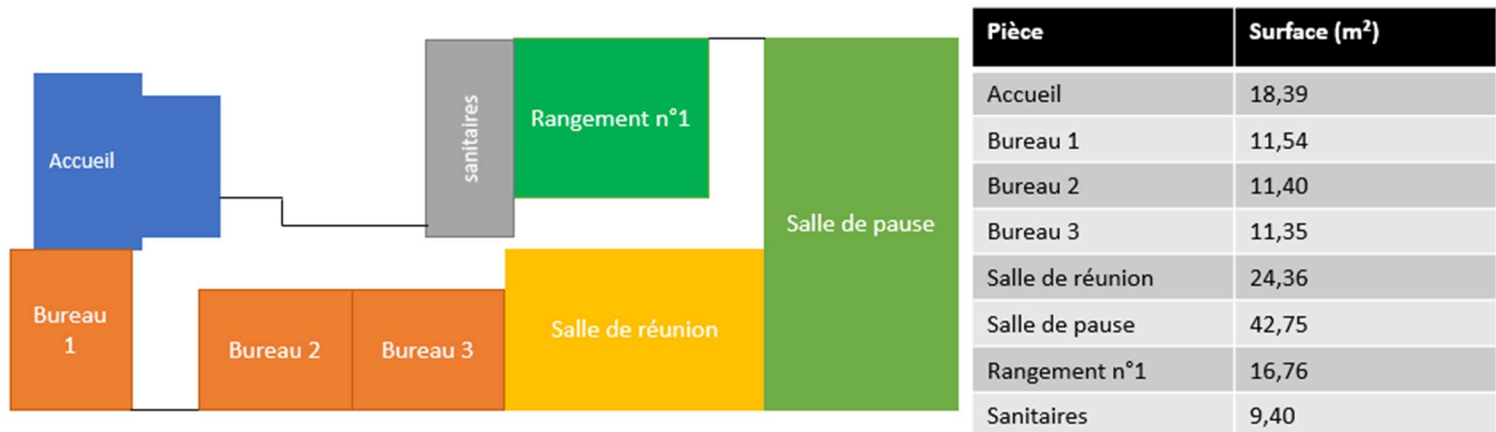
Plan de la zone « bureaux » et surface des différentes pièces
